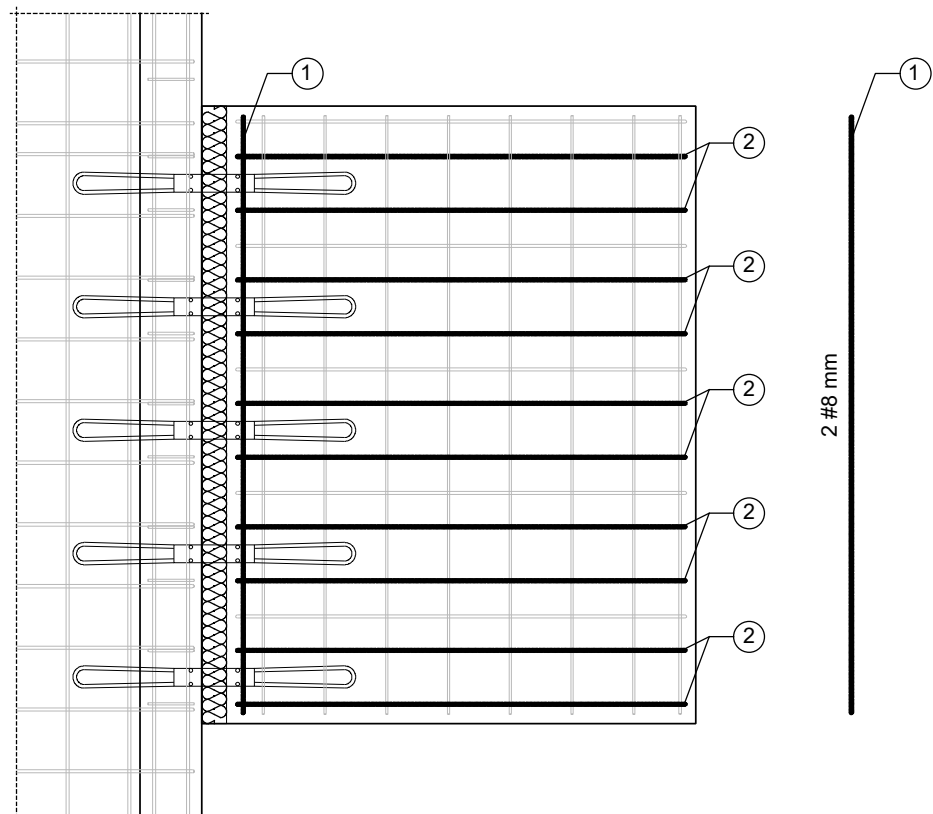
Przykład ułożenia zbrojenia głównego przy ramkach OMEGA
